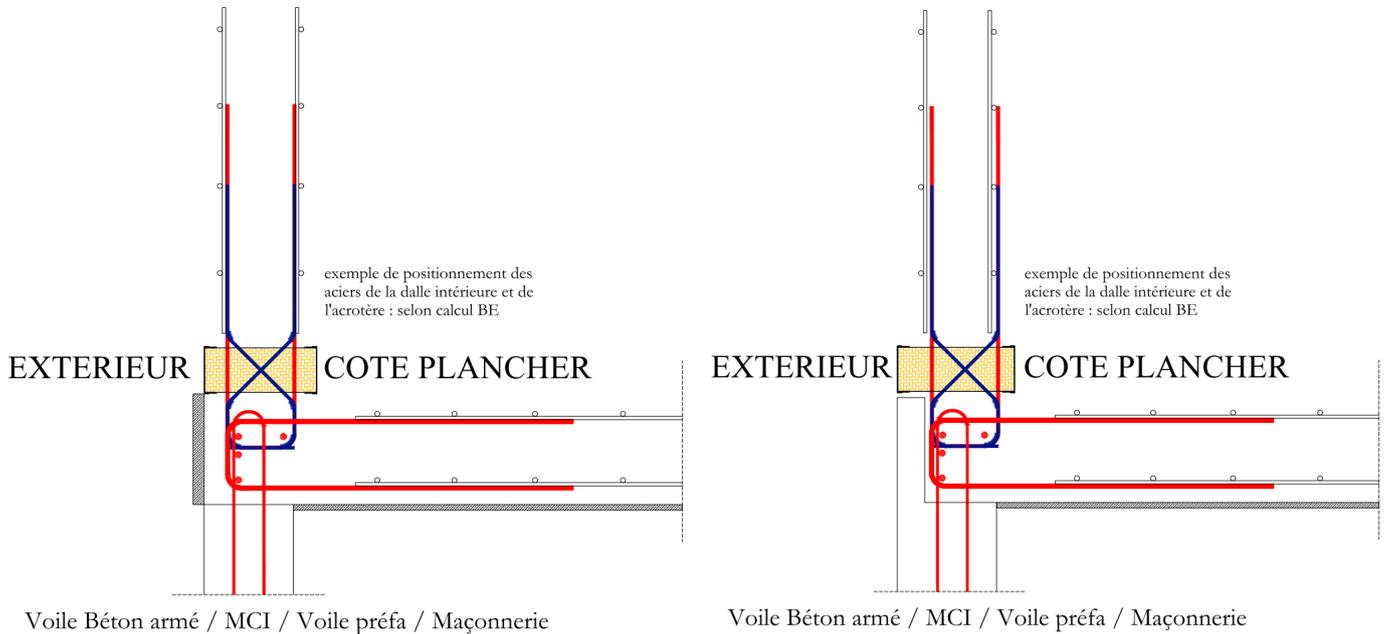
Détail de mise en place avant coulage, à gauche voile mise en place du coffrage de rive après coup, à droite coffrage de rive coulé avec le voile.
